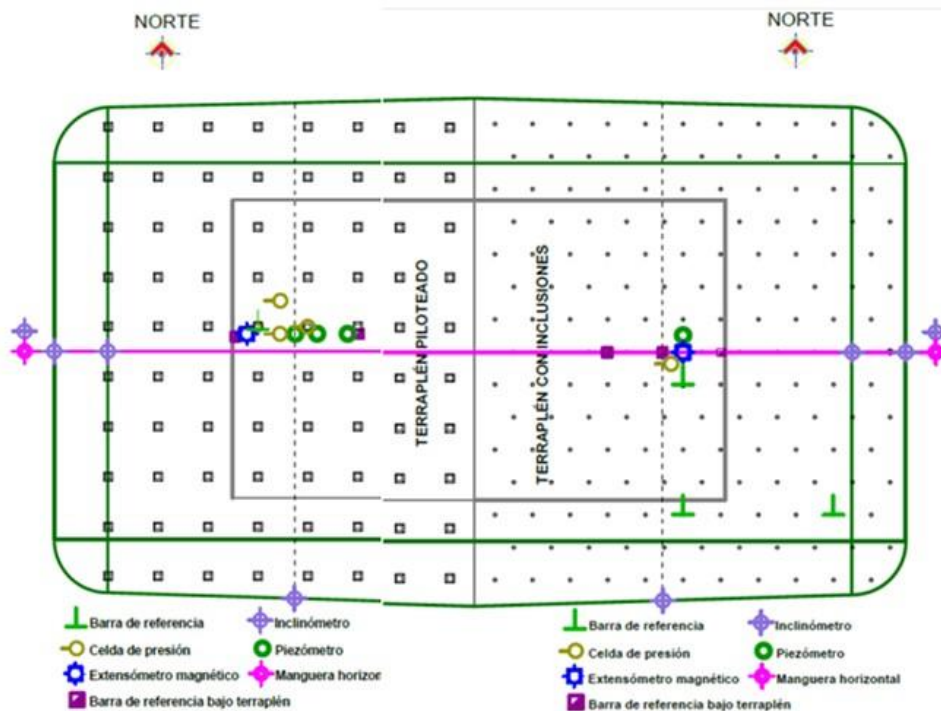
Esquema en planta de la instrumentación del TIP
